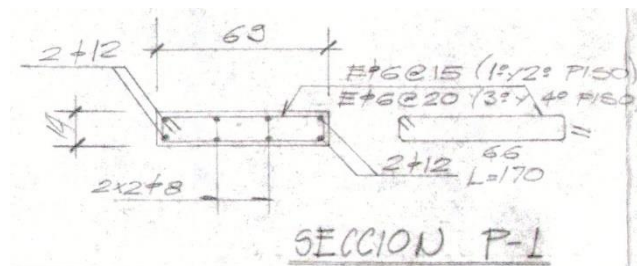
Dettaglio dell'armatura del pilastro dalle tavole originali di progetto
